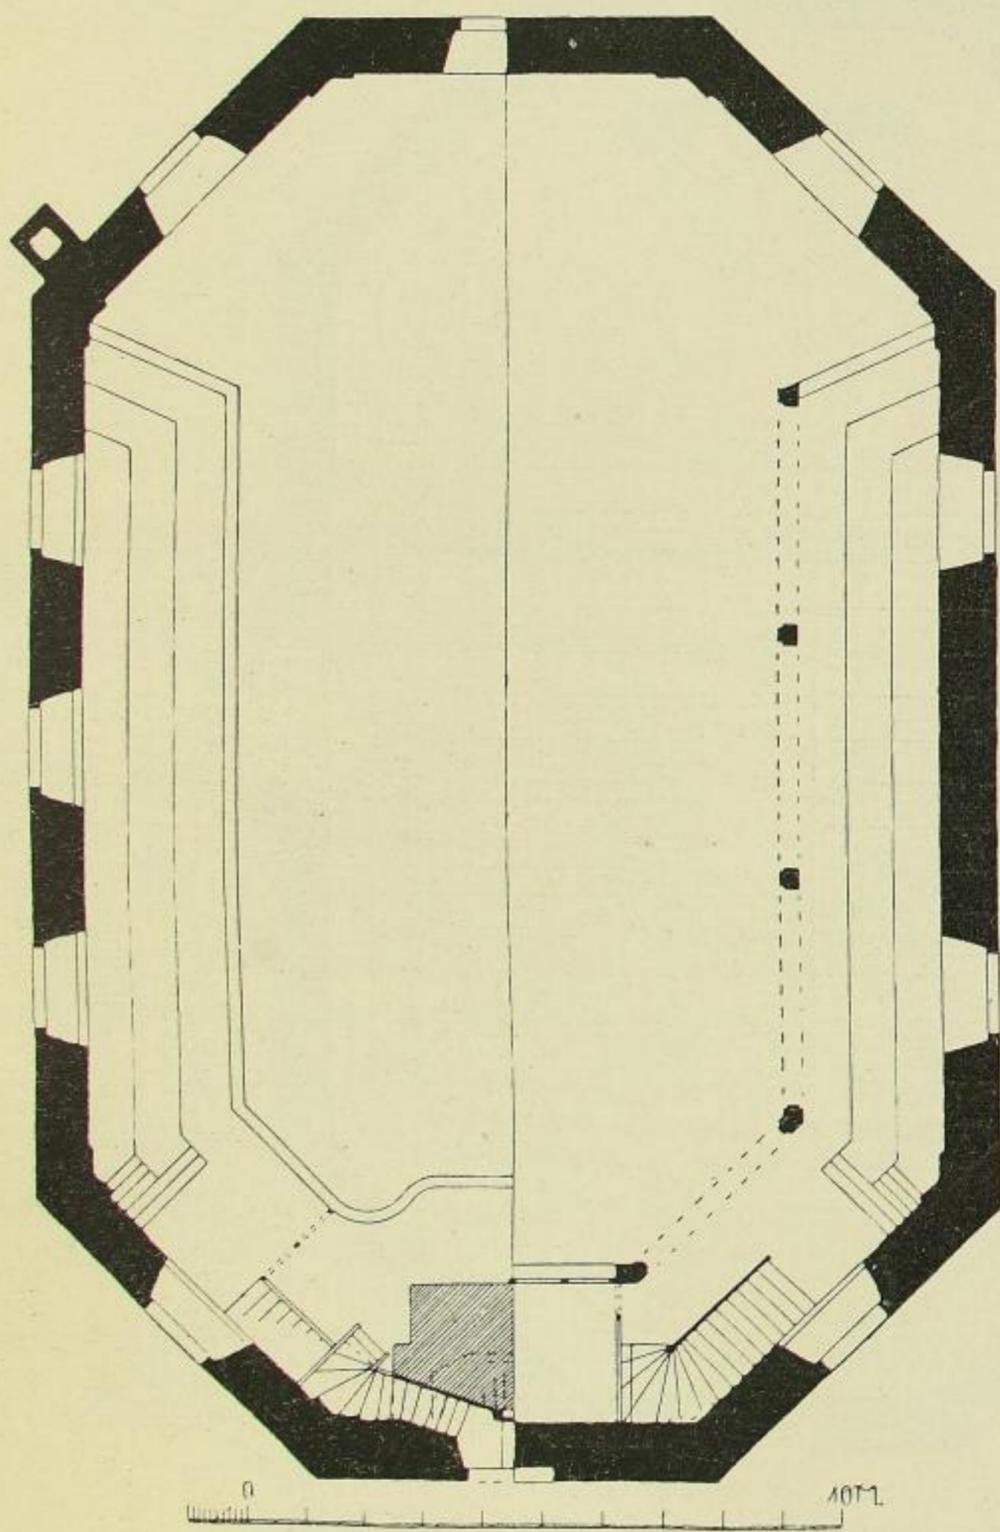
Loschwitz, Grundriss der Kirche.
